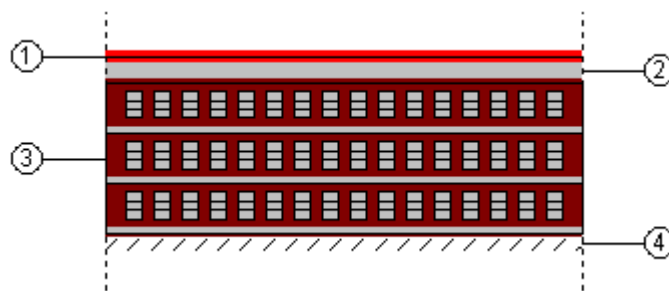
Detalle constructivo de los componentes del garaje.
